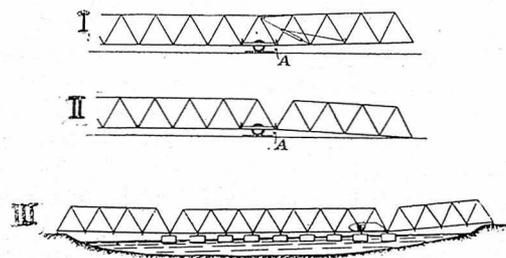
<sup>a</sup> I y II. Disposición articulada para el lanzamiento de los puentes pesados. III. Puente de pontones para tanks
